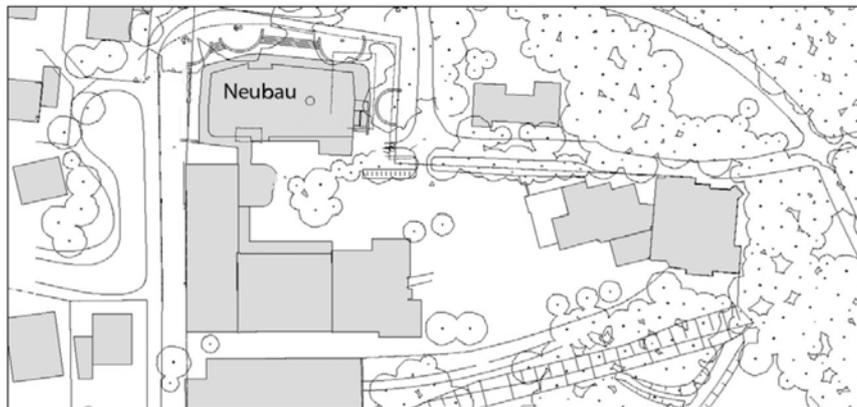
Lageplan Schule Am Oslebshäuser Park mit Neubau
